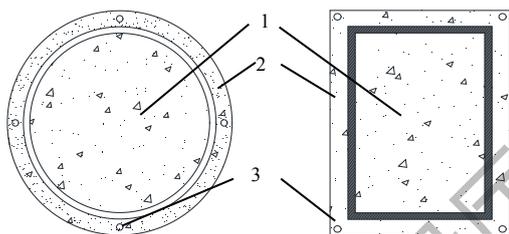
外包混凝土钢管混凝土柱防火保护构造
